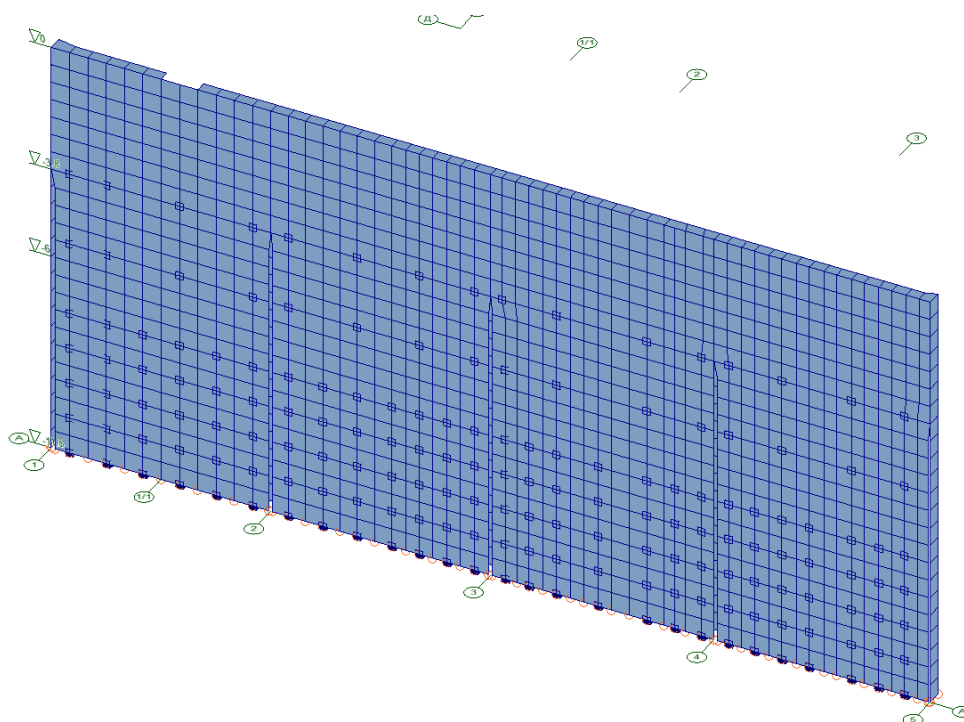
Схема расположения бетонных шпонок для обеспечения совместной работы «стены в грунте» и прижимной стены в оси А
